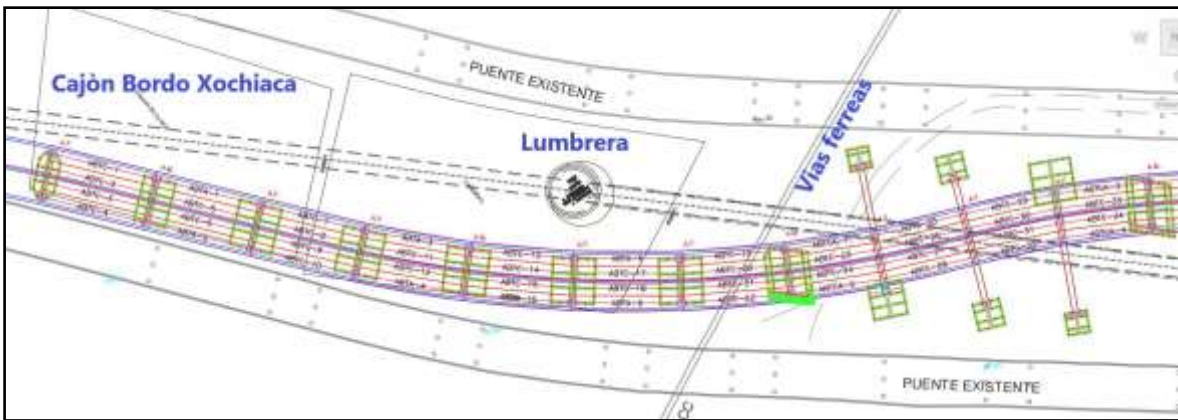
Planta de puente vehicular y colocación de traveses y cimentación parte 1.
